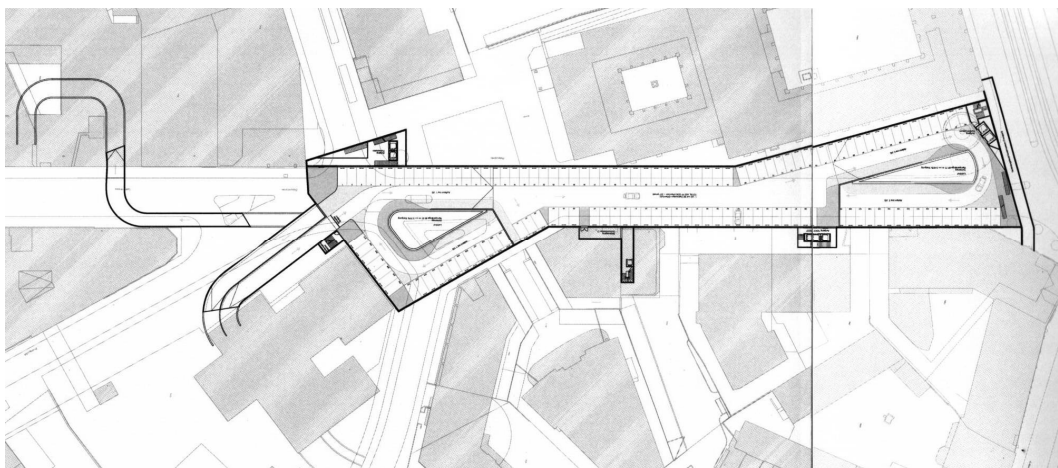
Parking «Picasso», Grundriss, Stand Planung 2008
